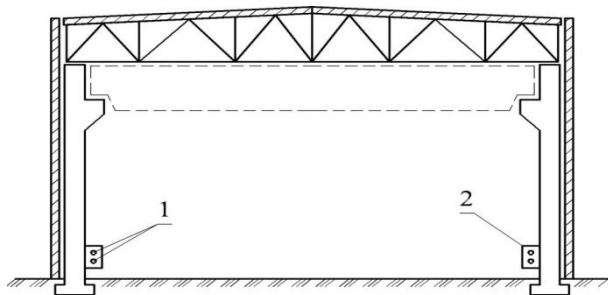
Схема прокладки водопровода в промышленных зданиях построенных на лессовых просадочных грунтах второго типа по просадочности:
